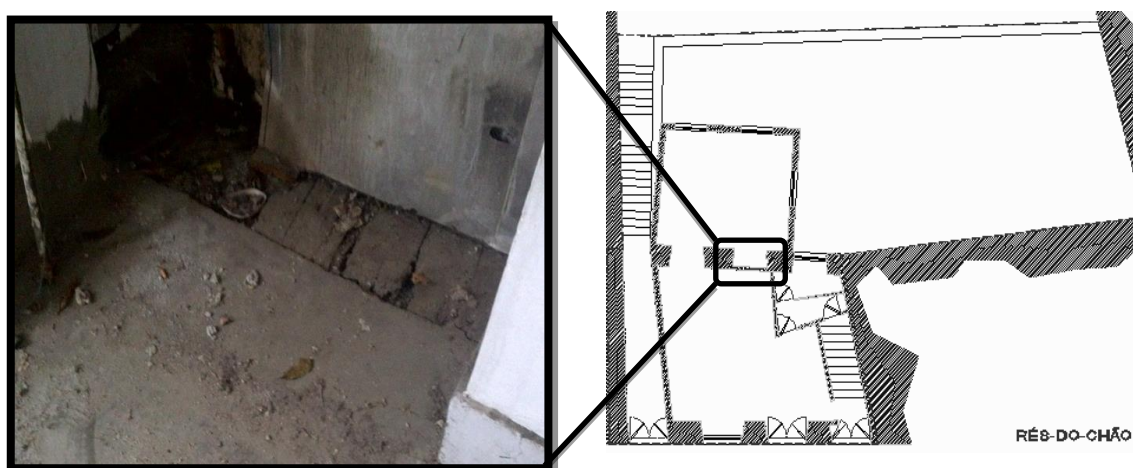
Anomalia 9 - Fotografia e localização em planta
